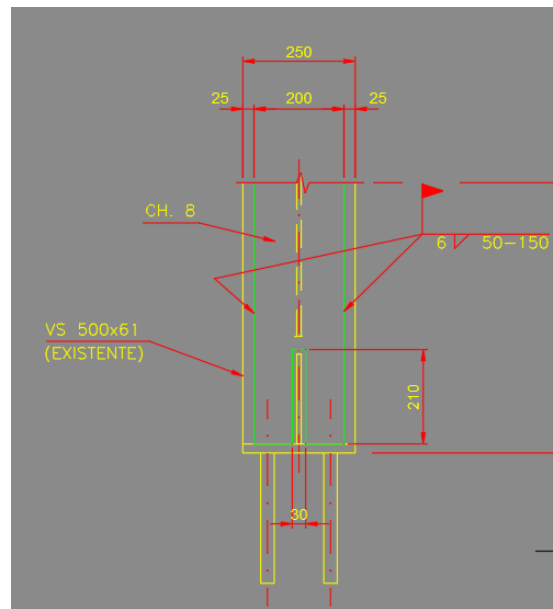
Vista do Pilar em Concreto Armado com Estrutura Metálica.
